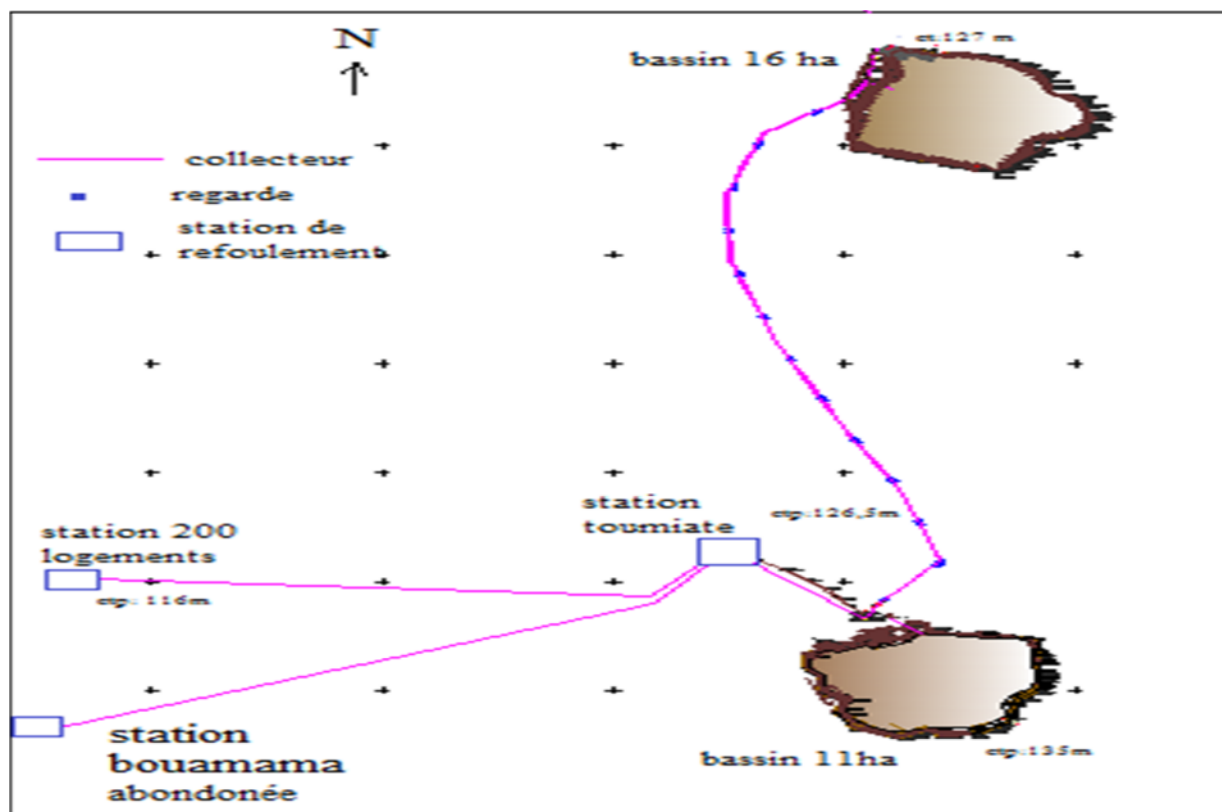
Réseau d'assainissement existant a l'aval de la ville
